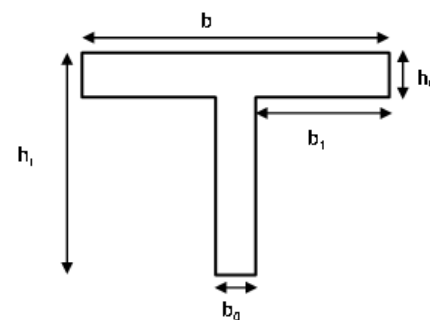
Schéma simplifié de la section en T de la poutrelle
